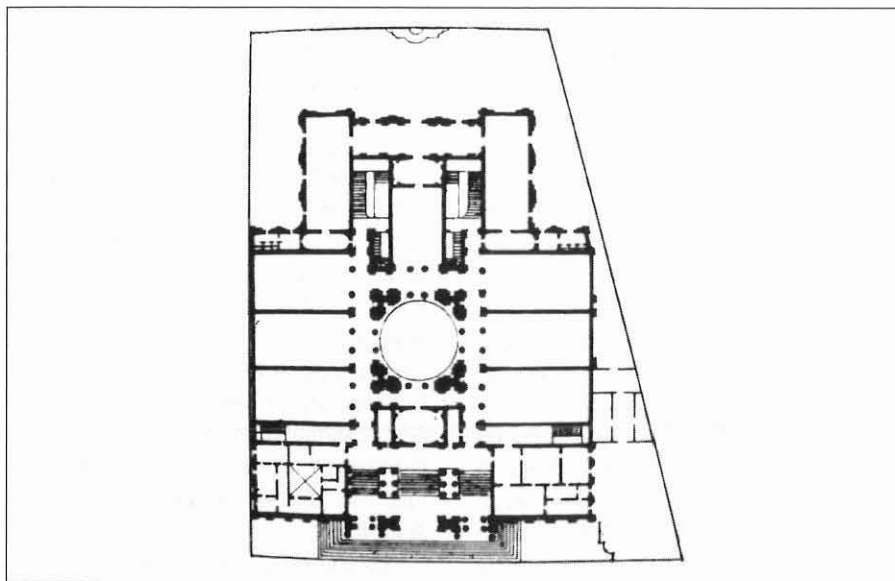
Roma, P. Piacentini, Palazzo delle Esposizioni, pianta piano di ingresso, 1877.
